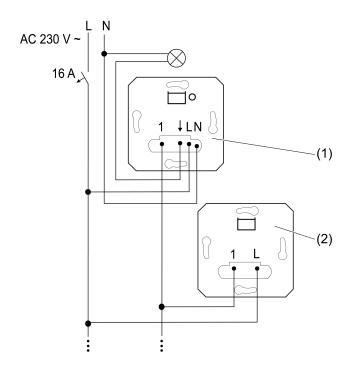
Anschlussplan 2-Draht-Nebenstellen
